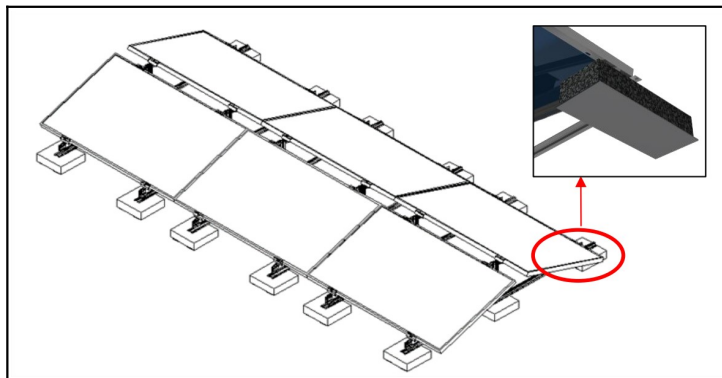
Exemple d'estructura autoportant llastrada a dues orientacions (Font: Solastem)
